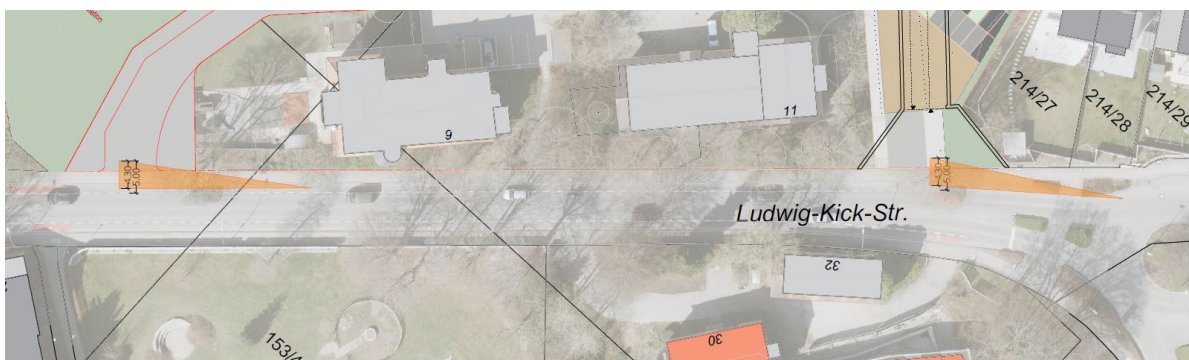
Sichtfelder beider Anbindungen auf den Radweg (BuP)
